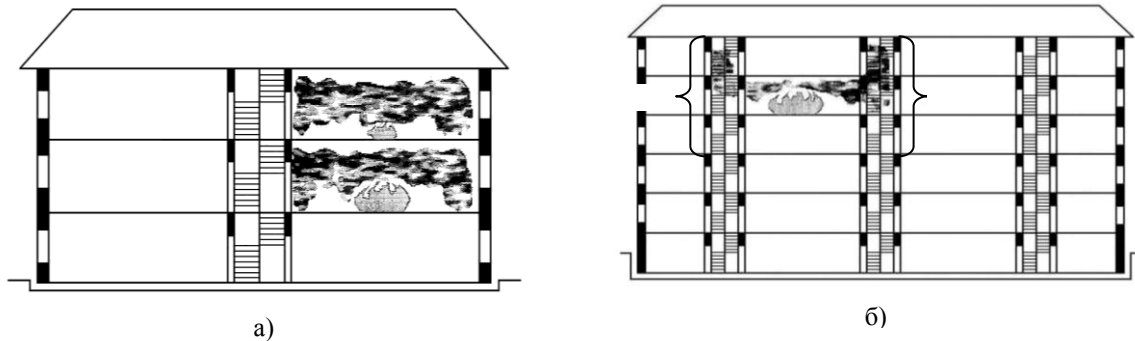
Створення оперативних ділянок у житлових та громадських будівлях: а) ОД по поверхах; б) ОД по сходових клітках
